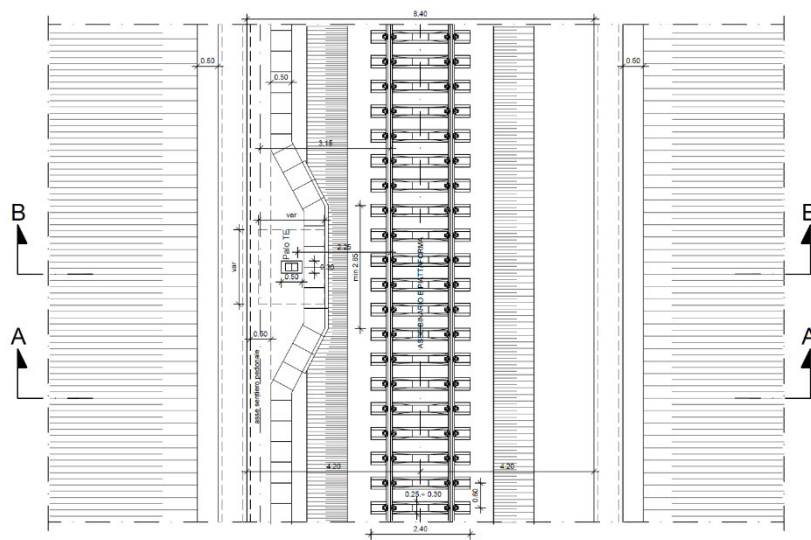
Stralcio planimetrico con sezione tipo ferroviaria in trincea a singolo binario in rettilo
